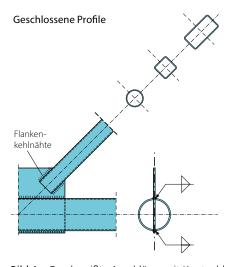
Geschweißte Anschlüsse mit Knotenblechen und unterschiedlichen Stabquerschnitten
